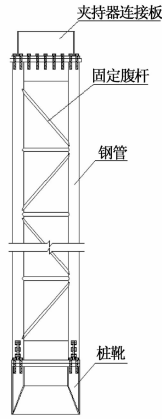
钢桁架式基坑支护结构与围护墙平行的剖面图
